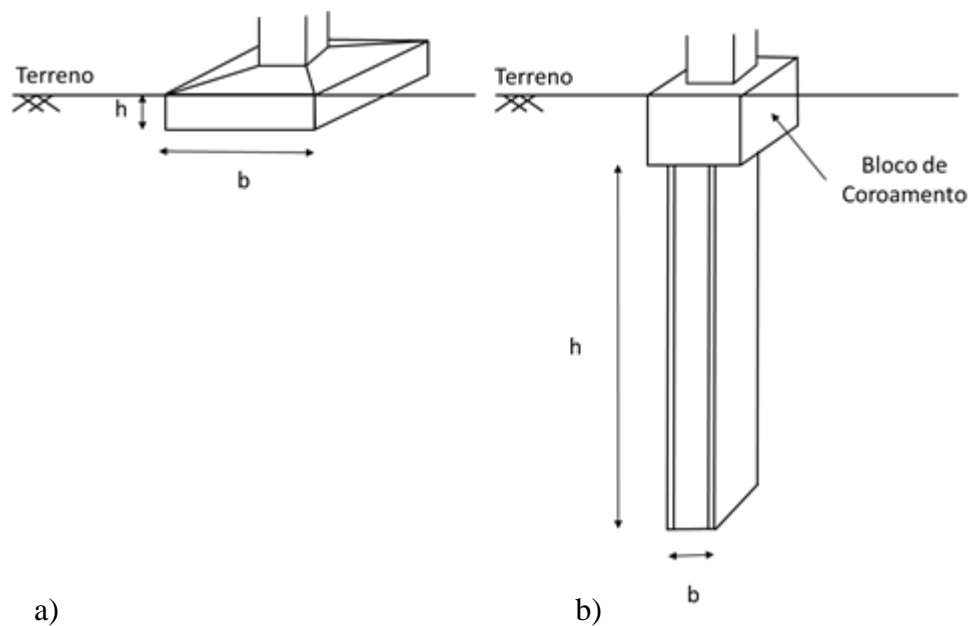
Tipos de fundação. a) Fundação superficial; b) Fundação profunda.
